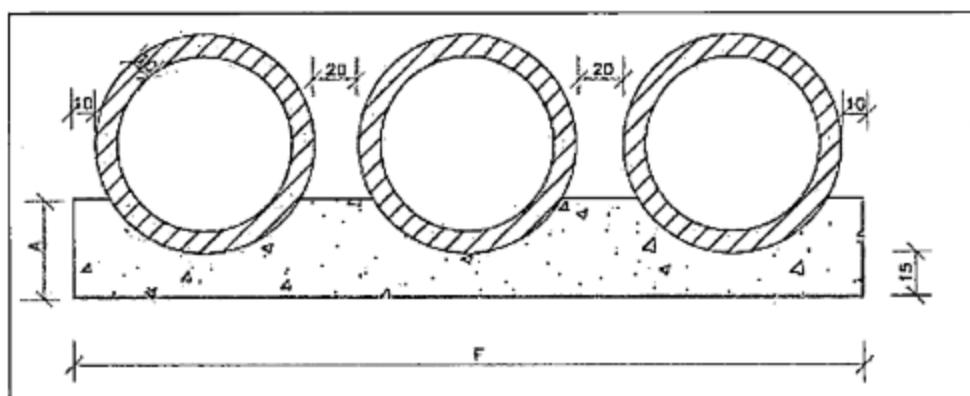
Bueiro triplo tubular de concreto, Manual de Dispositivos de Drenagem -Dnit
